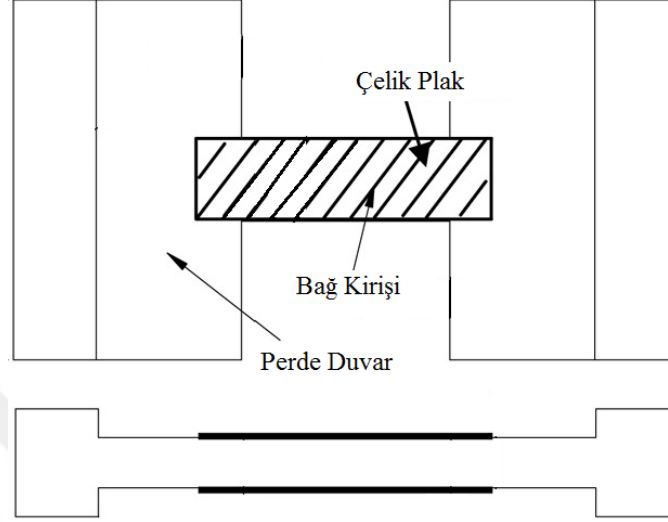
Plakla güçlendirilmiş betonarme bağ kirişi (Fortney, 2005)
